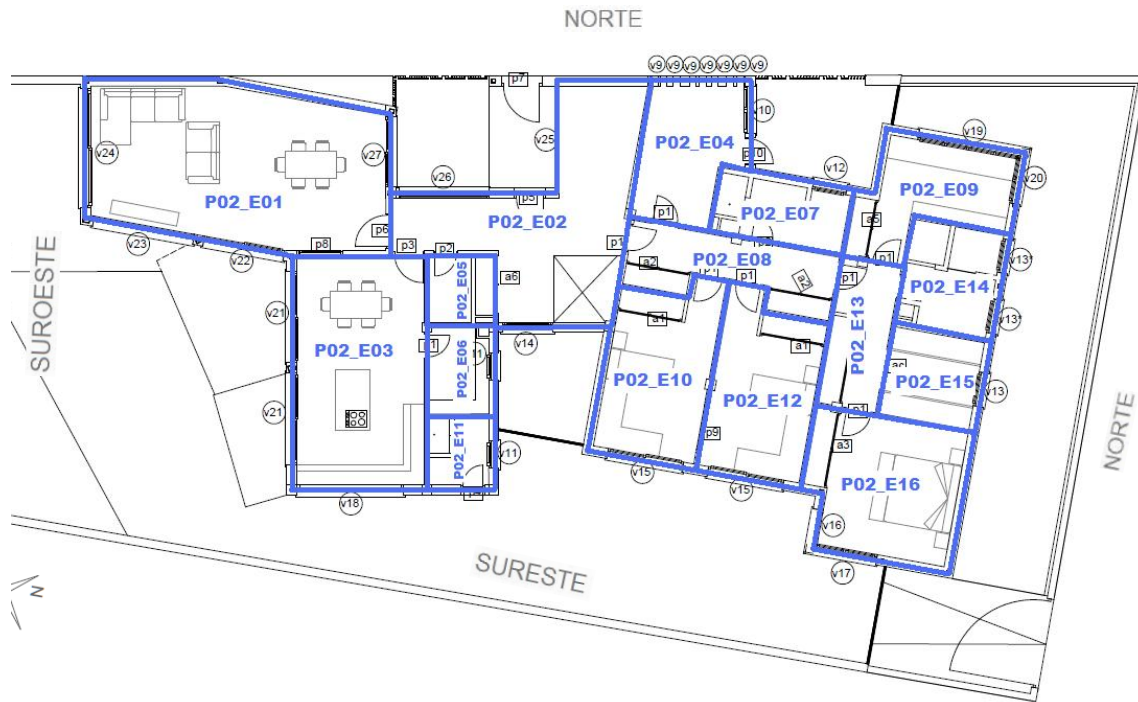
Planta baja. Vivienda unifamiliar de Loja.
